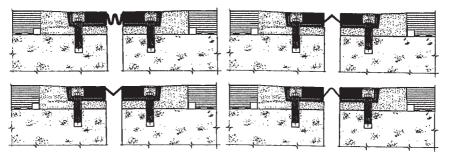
Juntas con banda de caucho con bloques de elastómero armado
